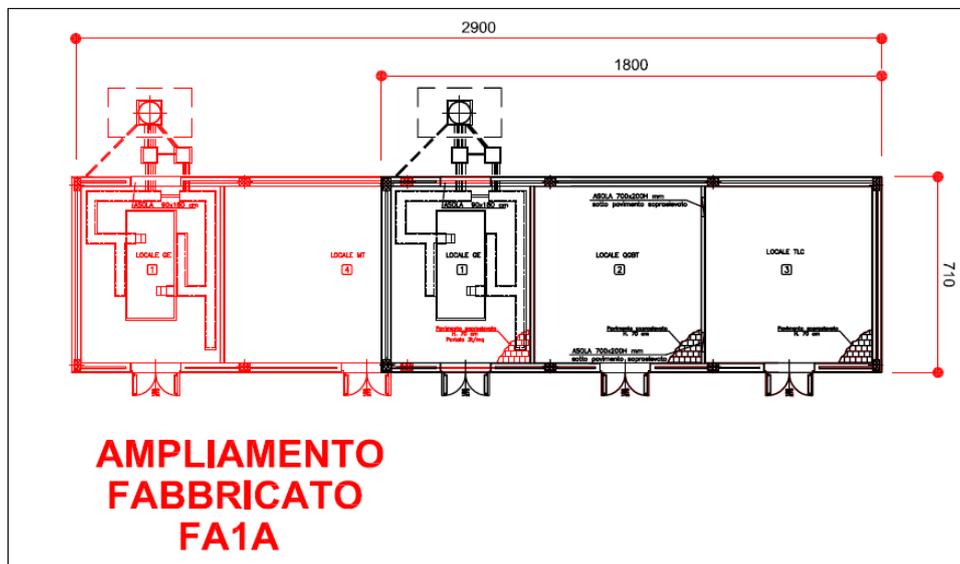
Planimetria di sovrapposizione. In nero la soluzione PD. In rosso la soluzione PDAP con planimetria più larga. L'altezza dell'edificio resta immutata tra PD e PDAP
